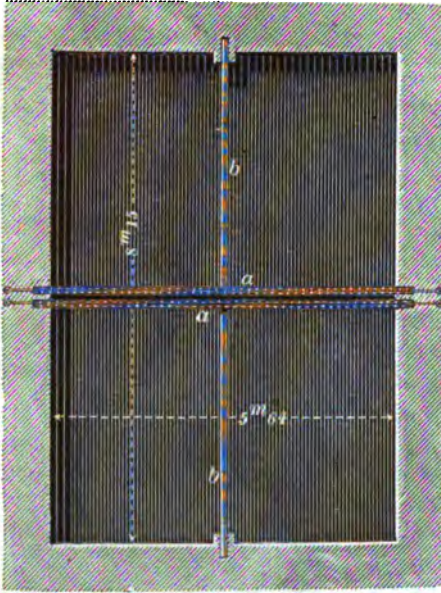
zeigt im Grundriss einen Fall, wobei ein in der unteren Etage befindlicher größerer Raum, der etwa zum Geschäftslocal dient, im oberen Geschloß durch zwei, sich rechtwinklig schneidende massive Mauern in vier Zimmer getheilt werden soll. Die ganze Länge des Raumes betrage  $8^m15$ , die Tiefe desselben  $5^m64$ . Um die Aufstellung von eisernen Säulen zu vermeiden, wird die  $1\frac{1}{4}$  Stein starke Mittelmauer, vergl. den Querschnitt Fig. 337, durch die beiden Blechträger  $aa$  unterstützt, während die  $\frac{1}{2}$  Stein starke Scheidemauer auf den T-Eisen  $bb$  anfruhren soll.
